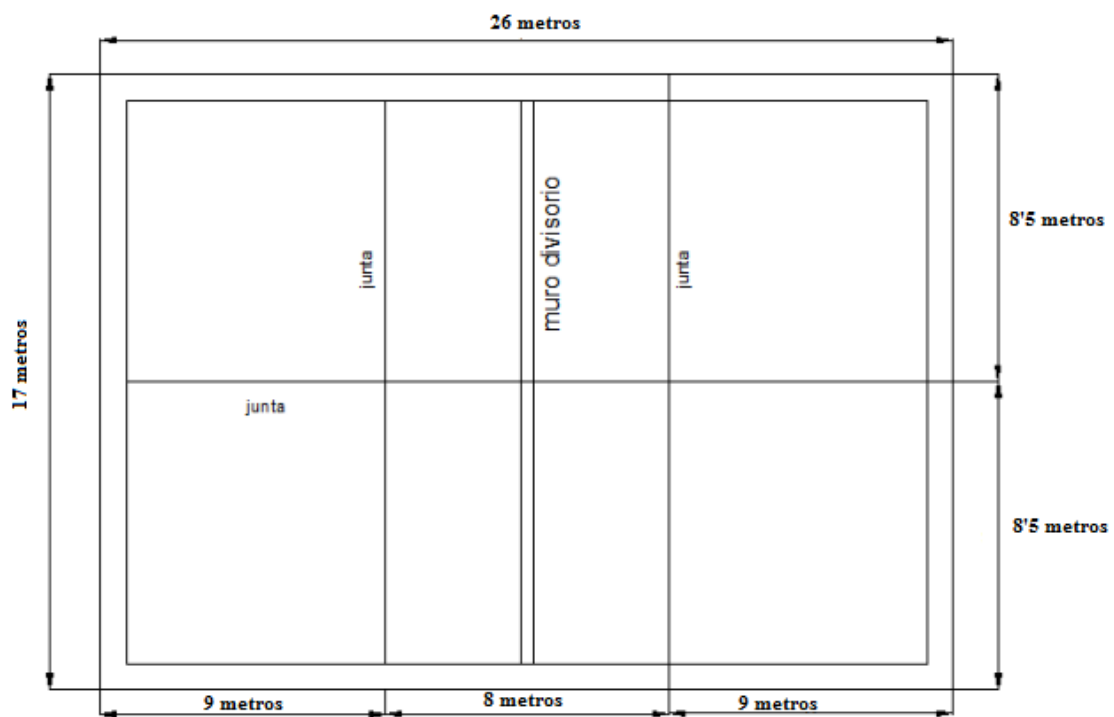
"Disposición de las juntas de dilatación. Fuente propia."
